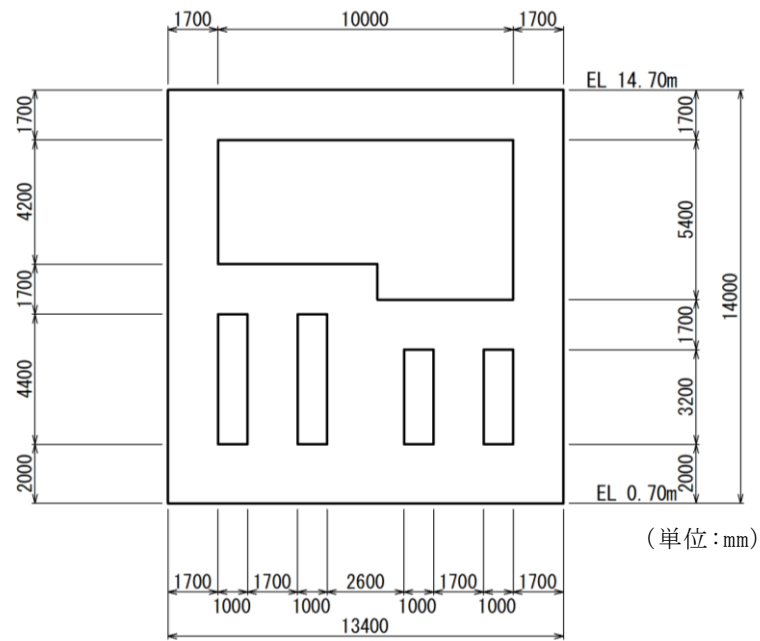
第 1 ベントフィルタ格納槽概略配筋図 (B-B 断面)
